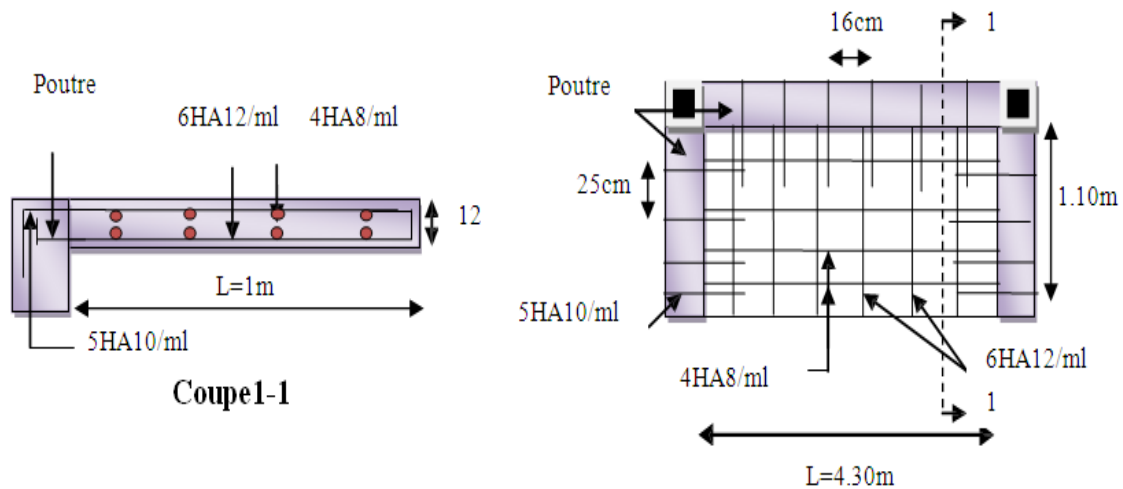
Schéma de ferrailage de la dalle pleine sur 3 appuis
